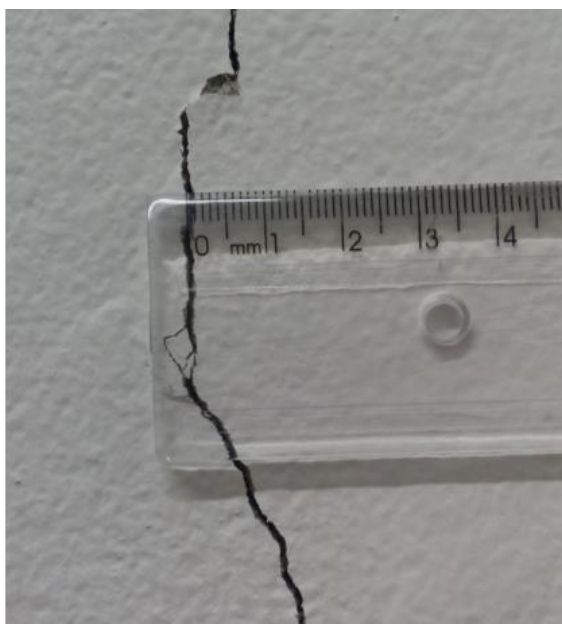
Ampliação da fissura do detalhe "g"
